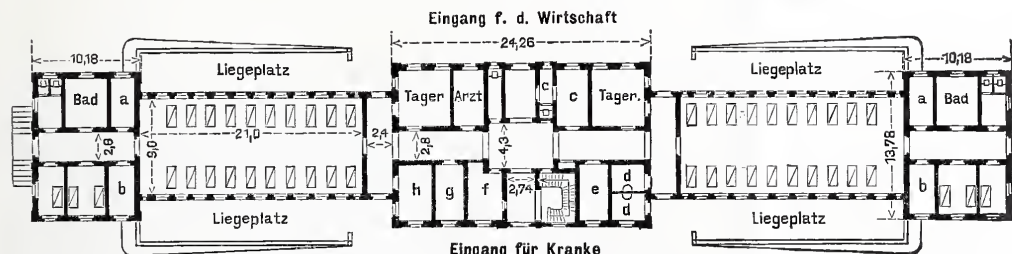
Kranken-Pavillon. Erdgeschoß.
